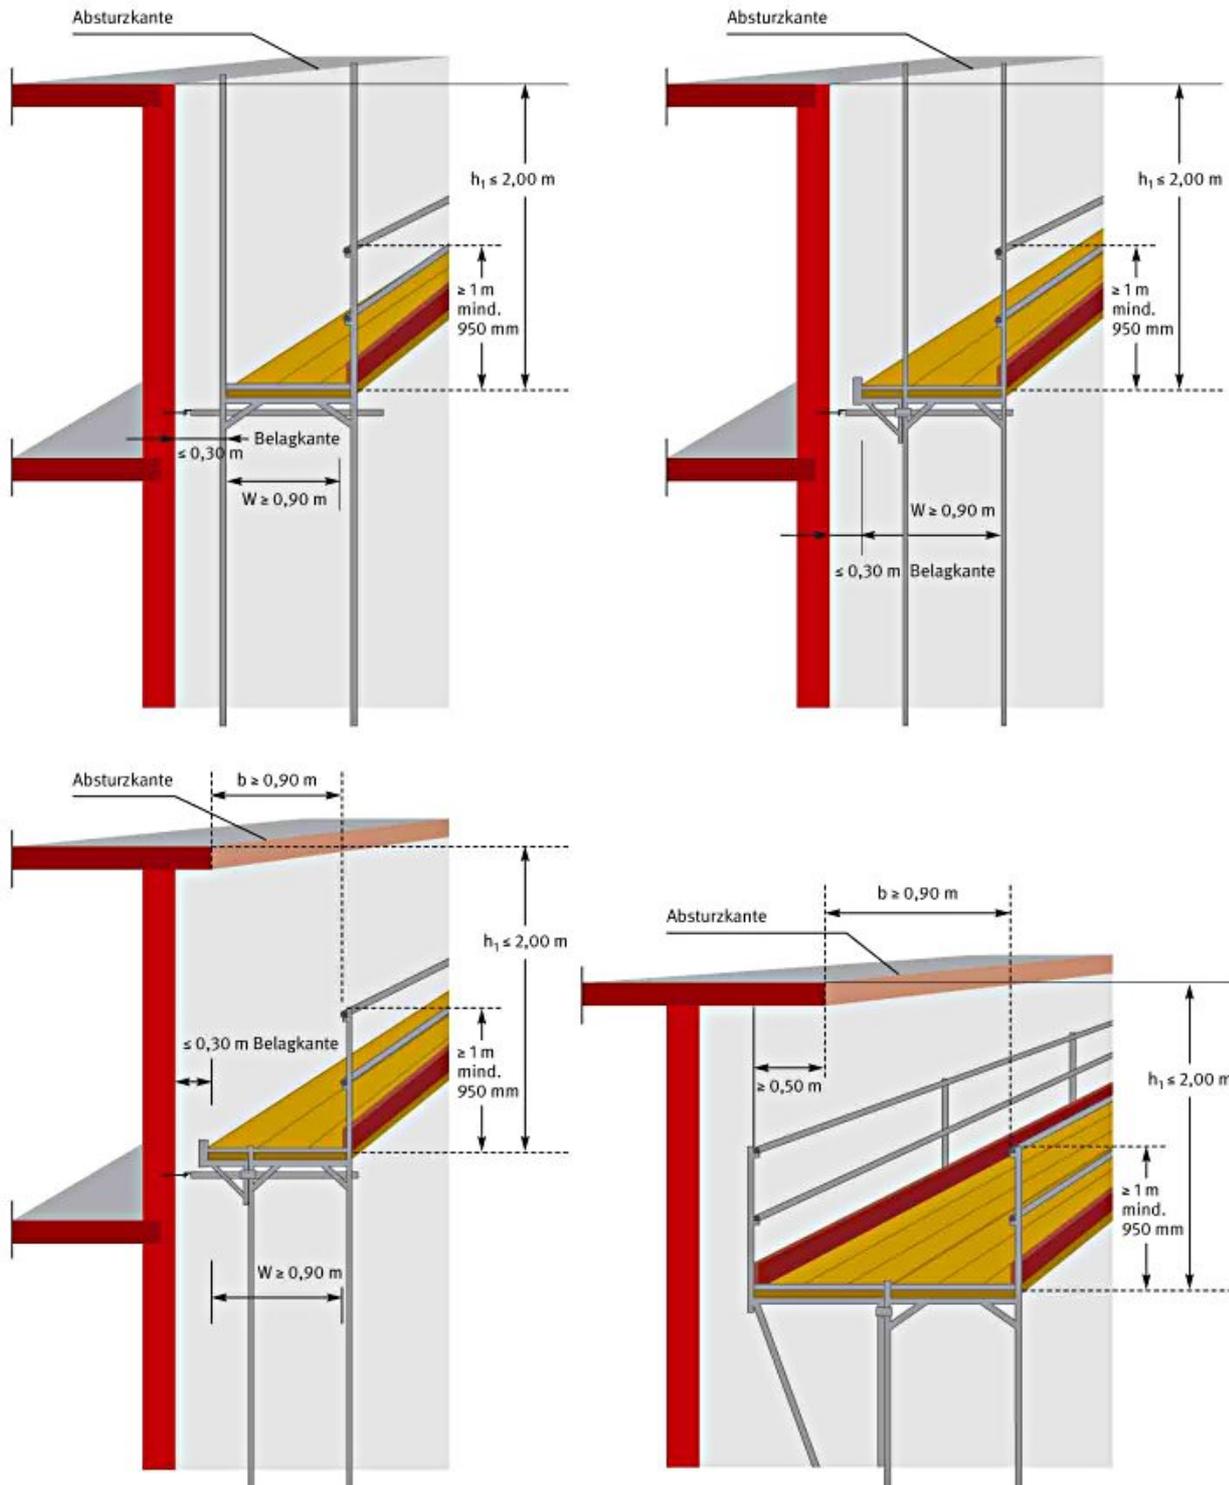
a bis Bild 16 d: Abmessungen der Fanggerüste
